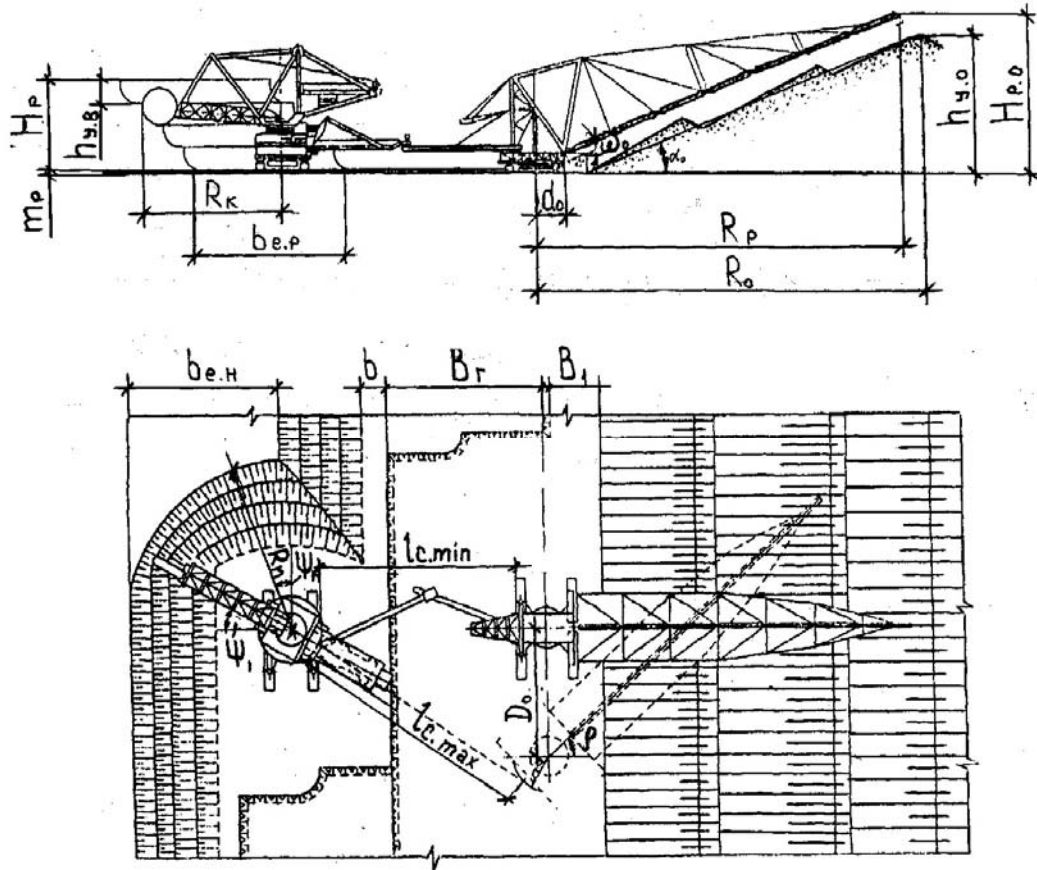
Схема до визначення ширини заходки роторного екскаватора
